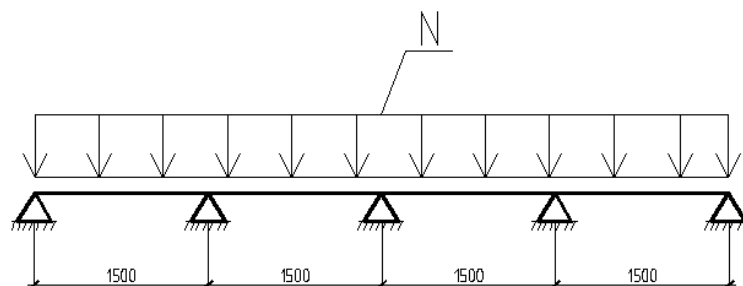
Схема распределенной нагрузки на разрезную балку.
